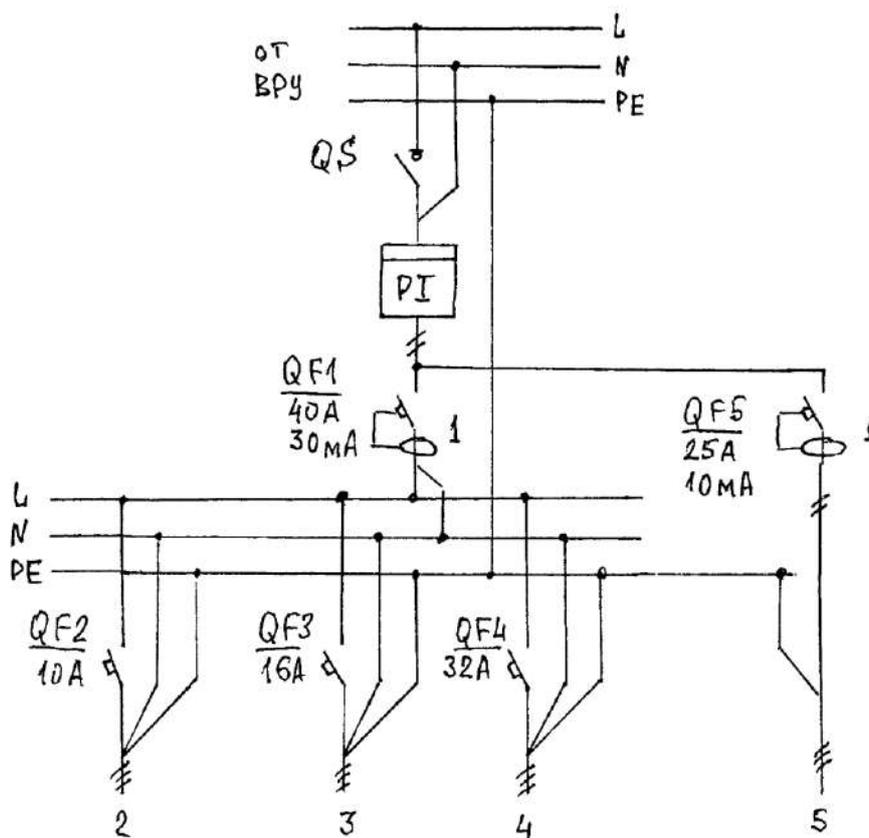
Принципиальная схема электроснабжения квартиры с системой заземления TN-S: 1 – УЗО; 2 – освещение; 3 – розетки; 4 – электроплита; 5 – ванная
